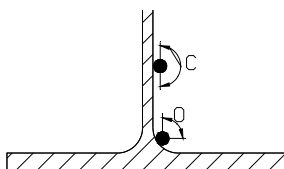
Perimetro efficace delle barre di armatura.
